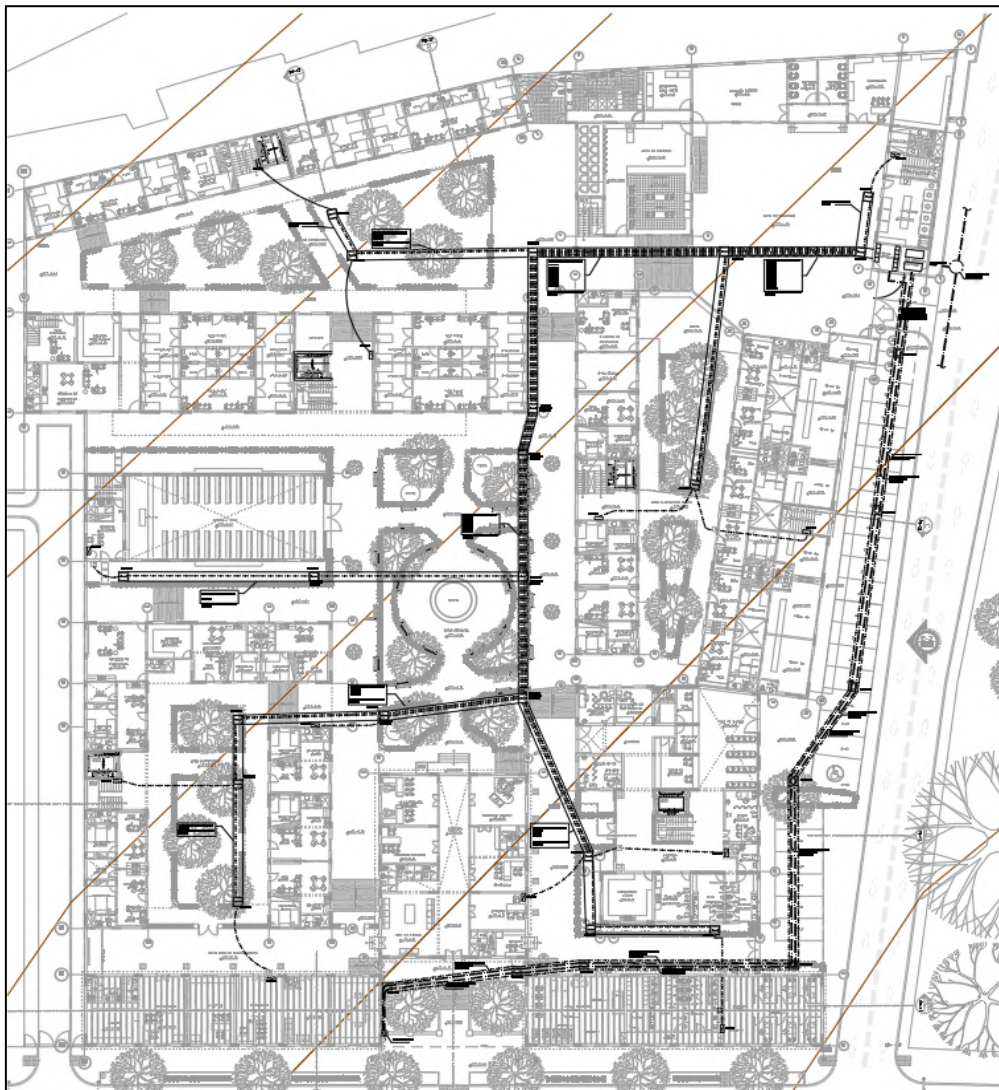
planteamiento general alimentación de energía eléctrica a los bloques desde el cuarto de tableros.
